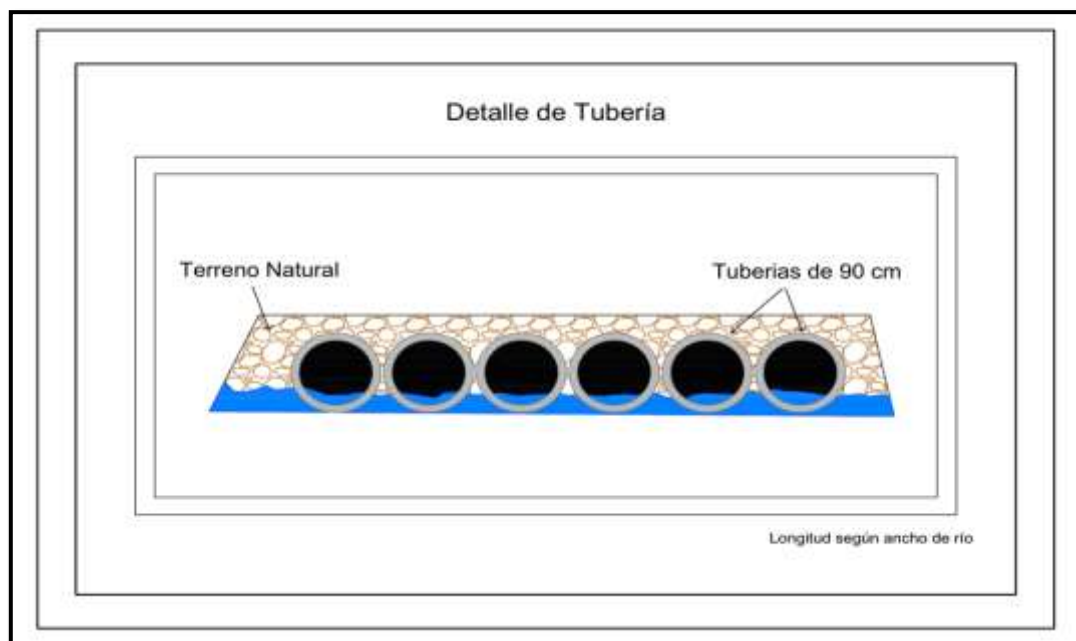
Detalle de tubos de hormigón para cruce o camellón.
